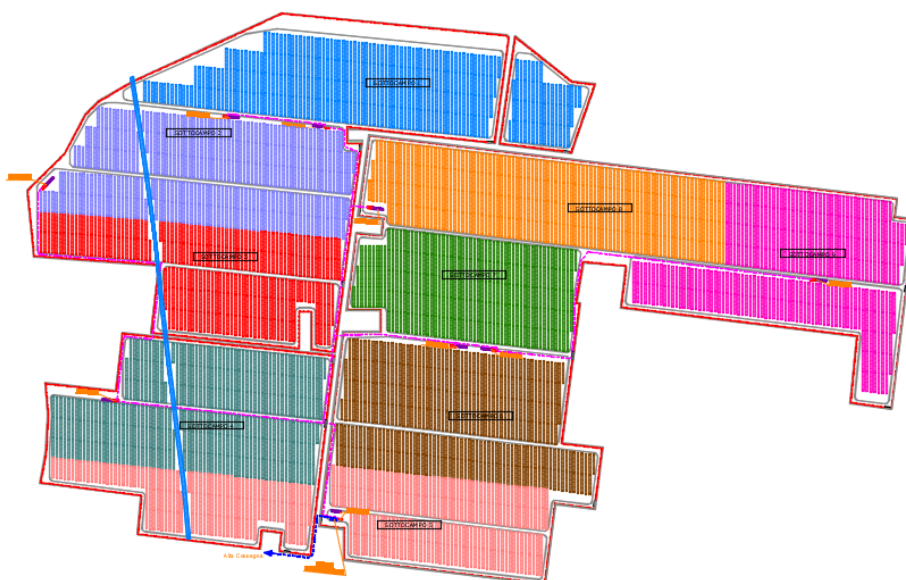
Planimetria con individuazione degli inverter ai fini del calcolo
